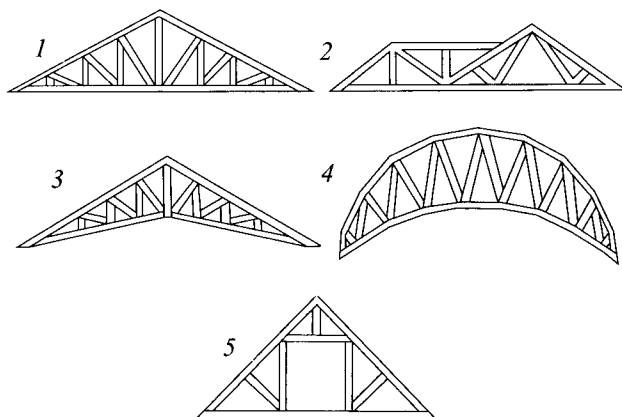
Конструкції ферм для індивідуальних будинків:
